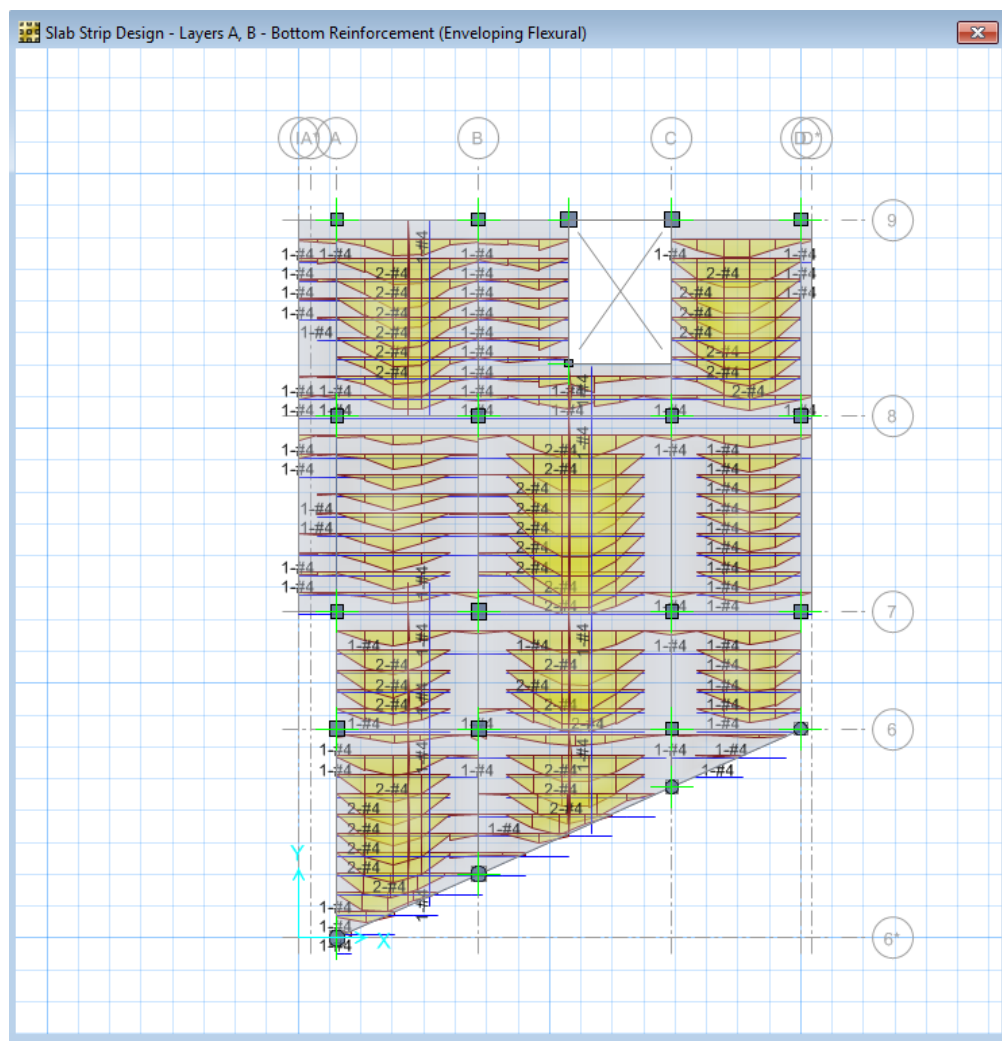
Acero Inferior Requerido en Losa Nervada. Edificio Módulo 2.
